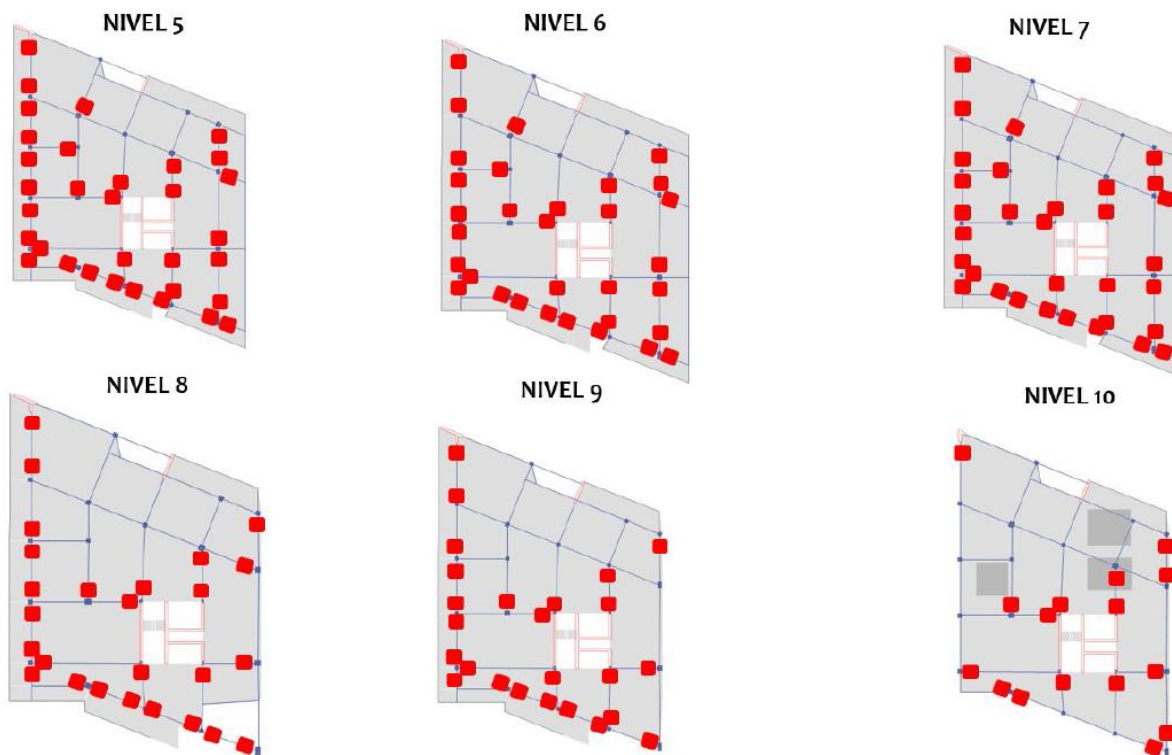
Ubicaciones de vigas a reforzar en los niveles 5 al 10
